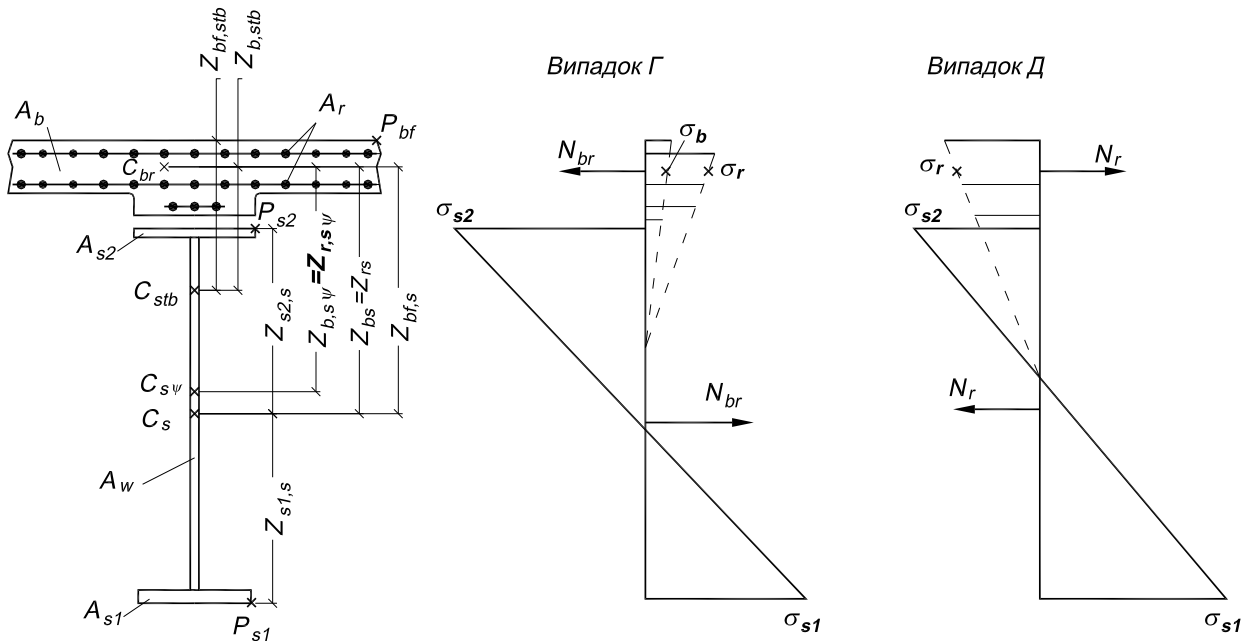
Розрахункові випадки розподілу напружень у нормальному сталезалізобетонному перерізі при наявності від'ємного згинального моменту.
